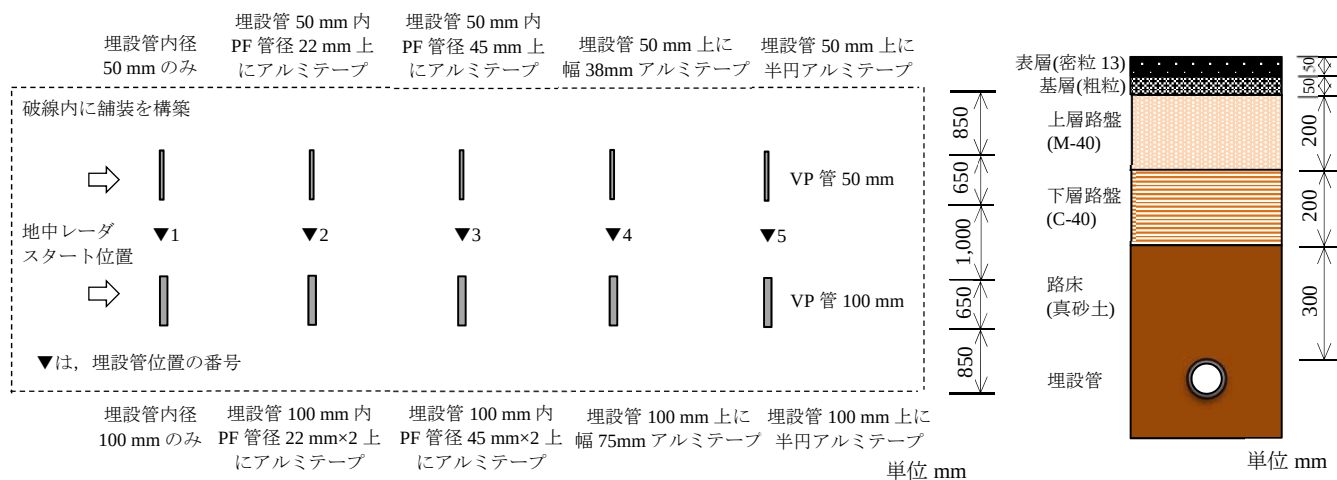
施工の平面図(埋設深さ 0.8 m 固定)
